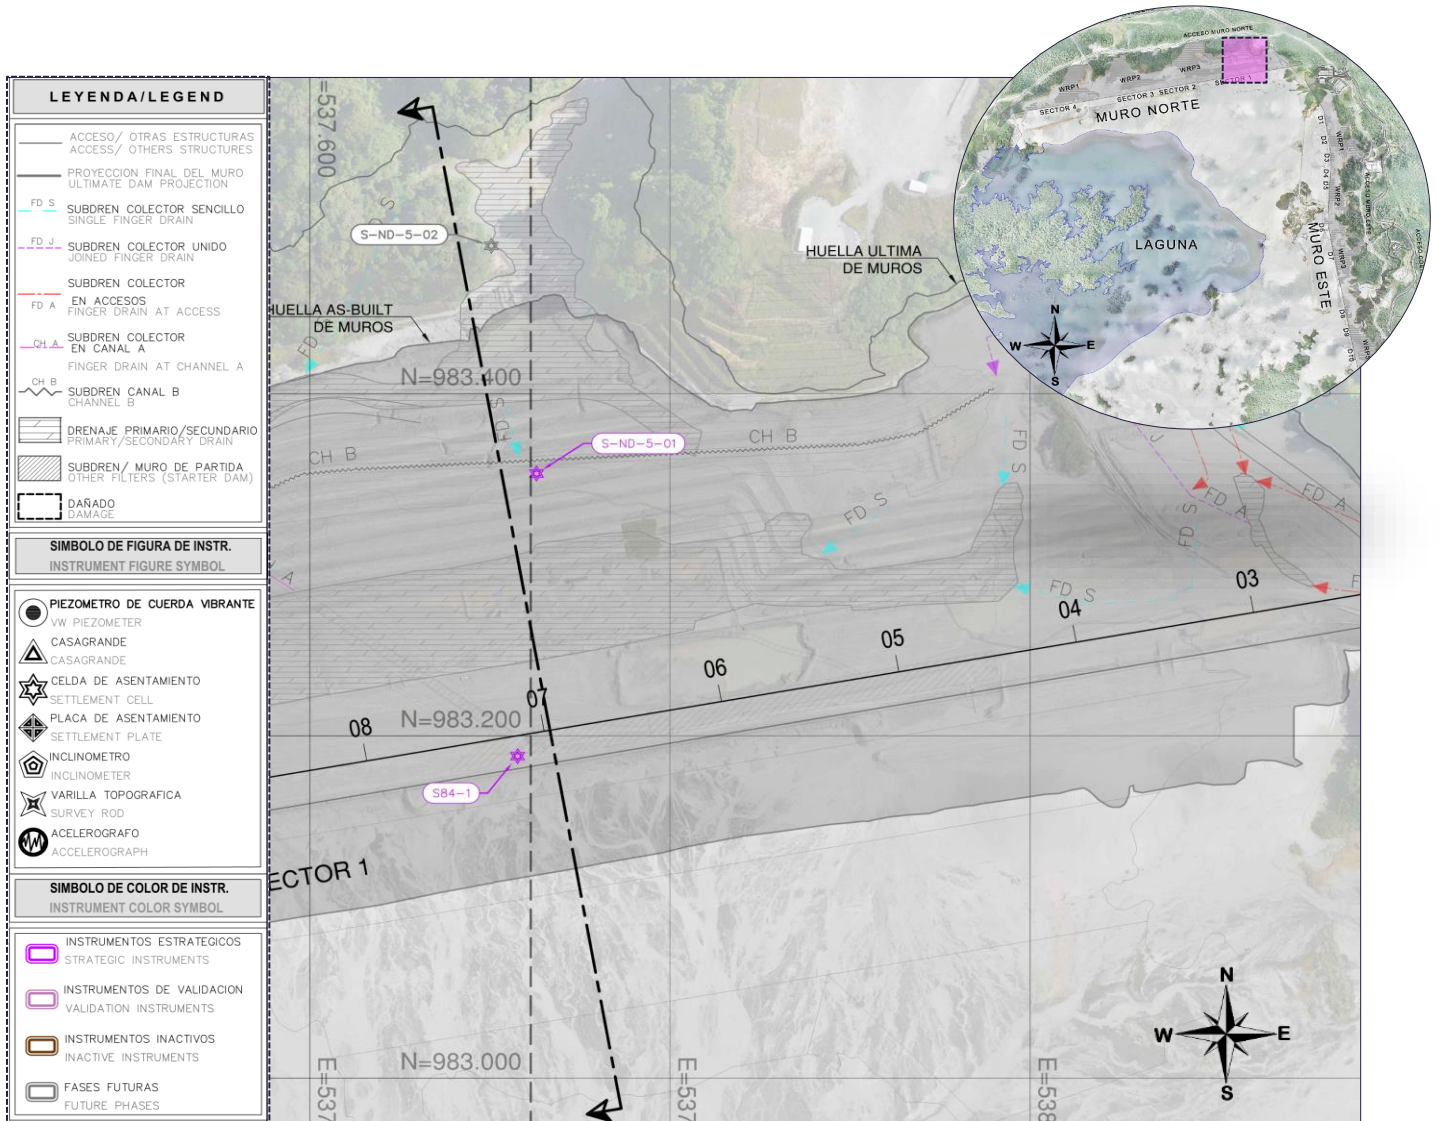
Vista de Planta en el Muro Norte Sector 1 con las Celdas de Asentamiento
